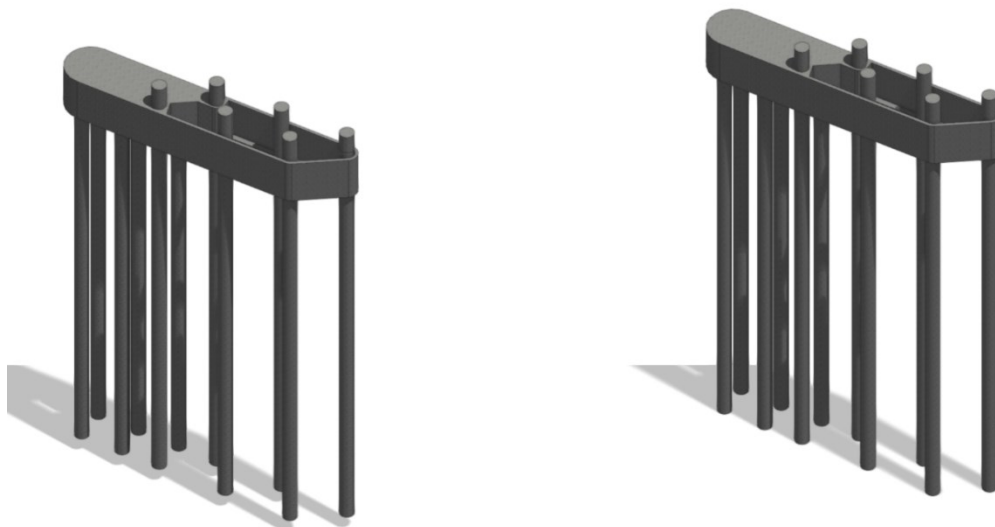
Rispettivamente Pila Venezia e Padova impalcato Nord
